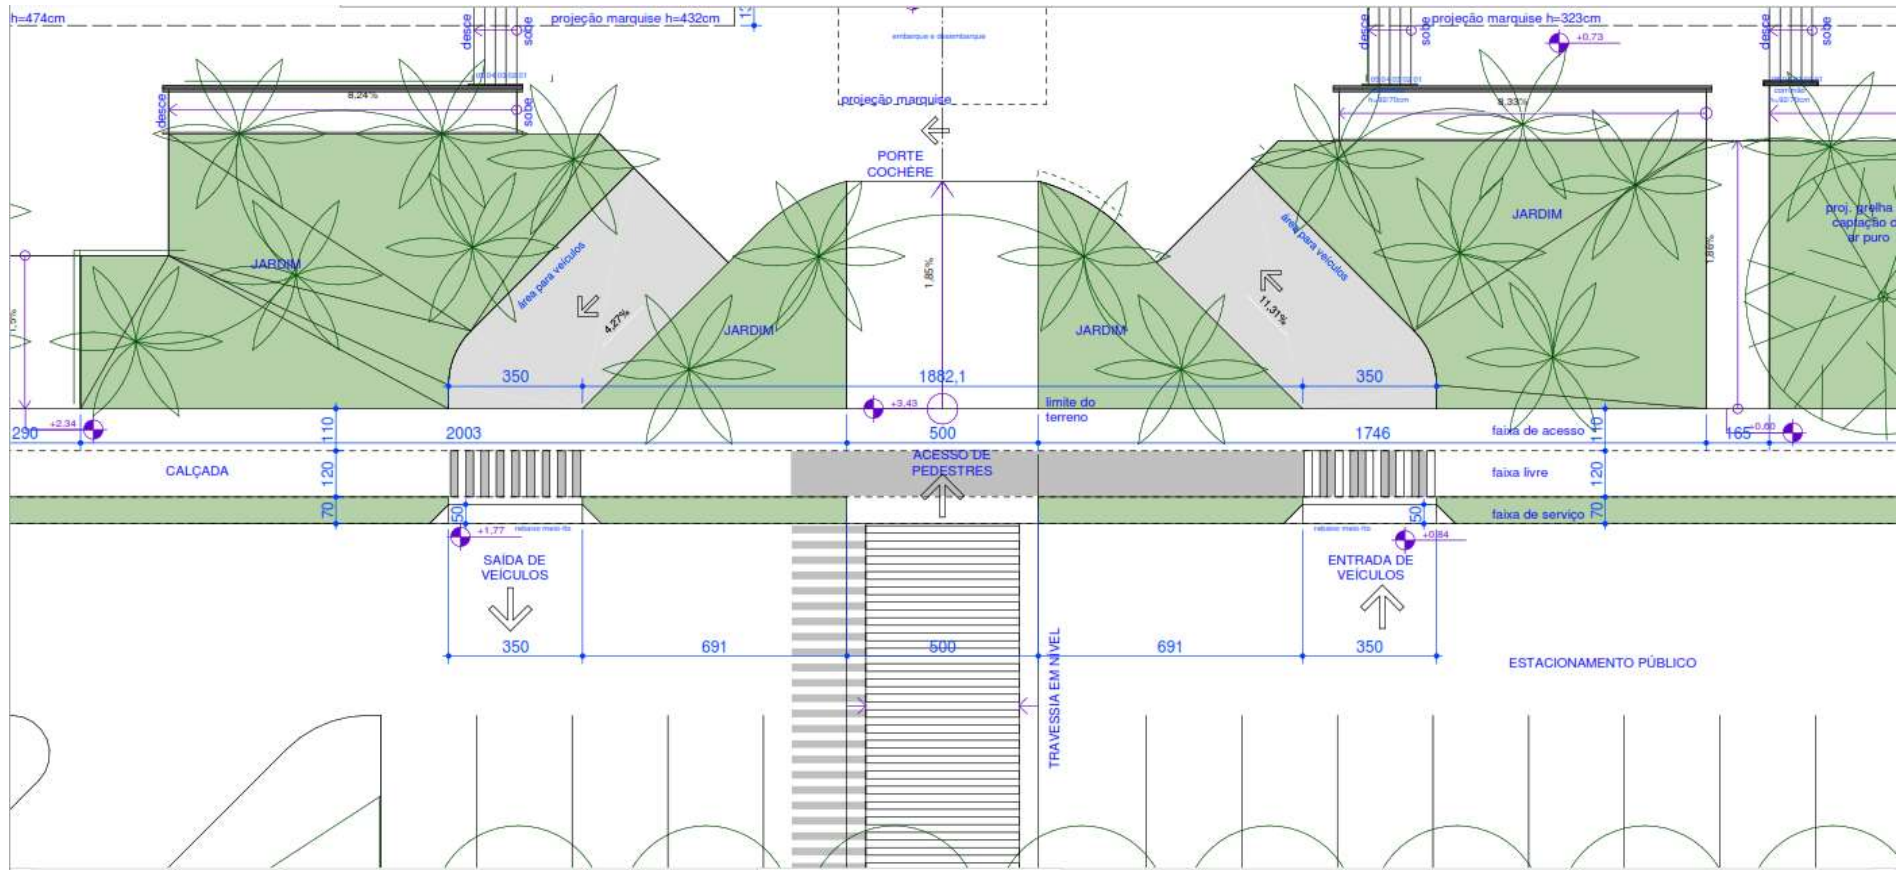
Destaque para embarque e desembarque incluindo detalhamento do projeto das calçadas.
